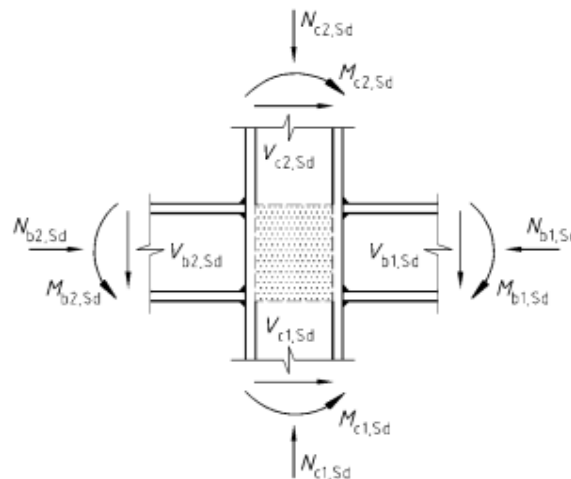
Sollicitations agissant sur un assemblage poteau-poutre
